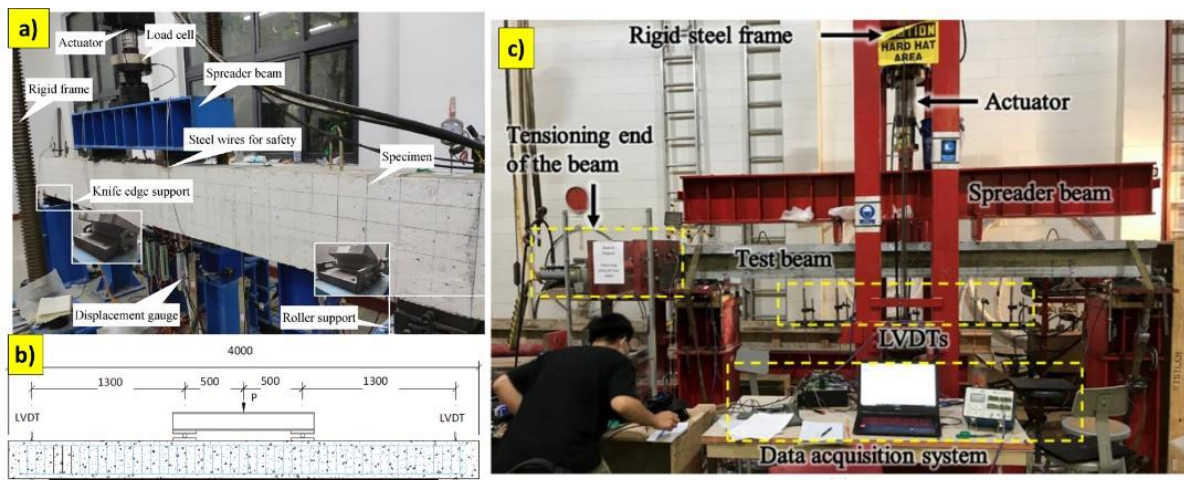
20 : a-c) : Dispositifs d'essai de flexion quatre points utilisés pour l'étude des coupleurs dans les poutres en béton armé, b) dimension de la poutre en béton armé [56] [57] [58]
